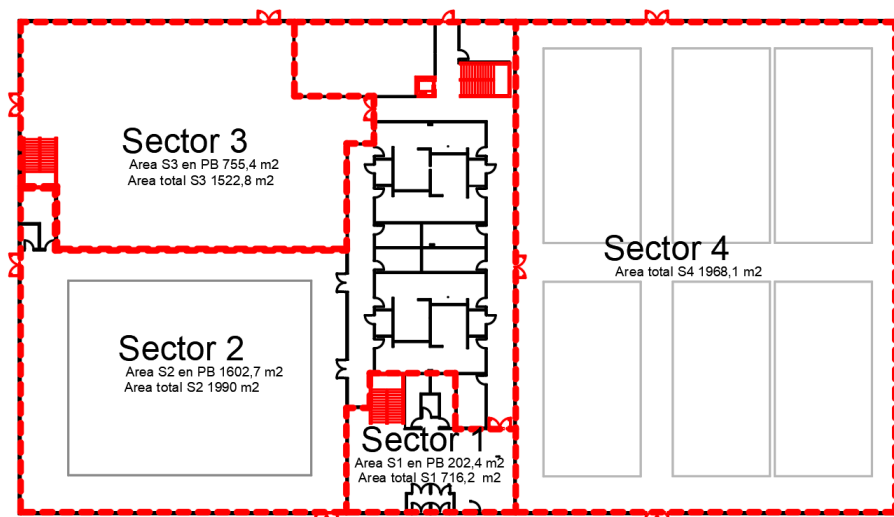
Sectorización planta baja (PB) y superficie de los sectores.
